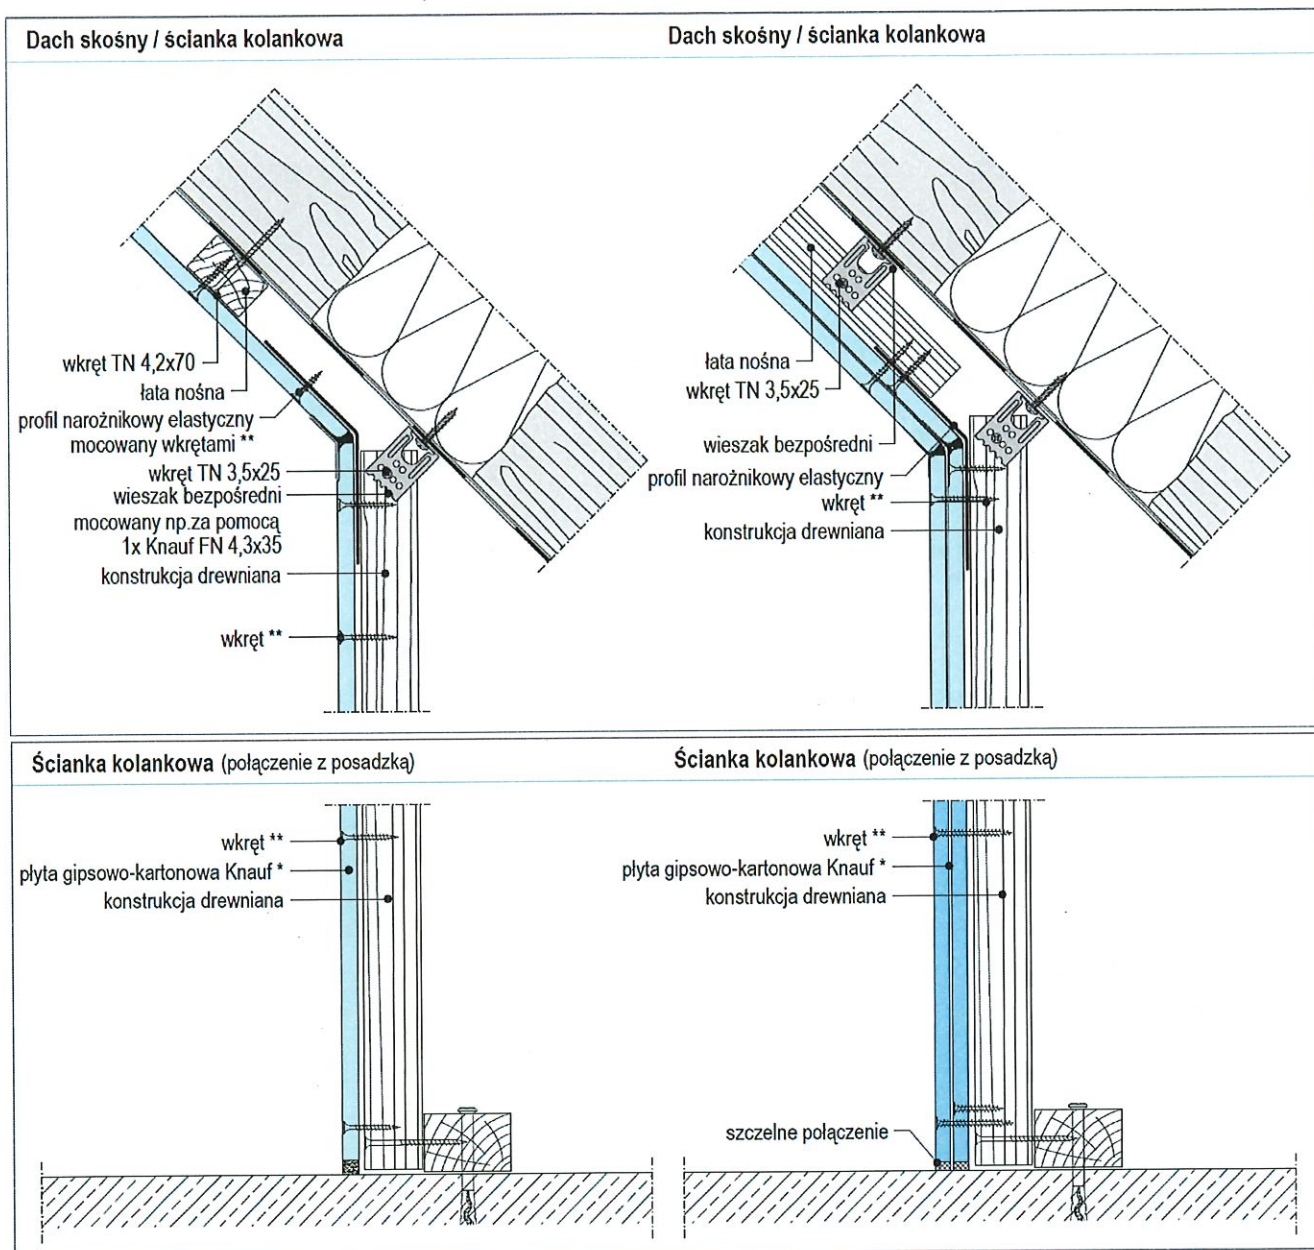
System D611.pl na pojedynczej konstrukcji, przekrój pionowy dachu spadzistego.
